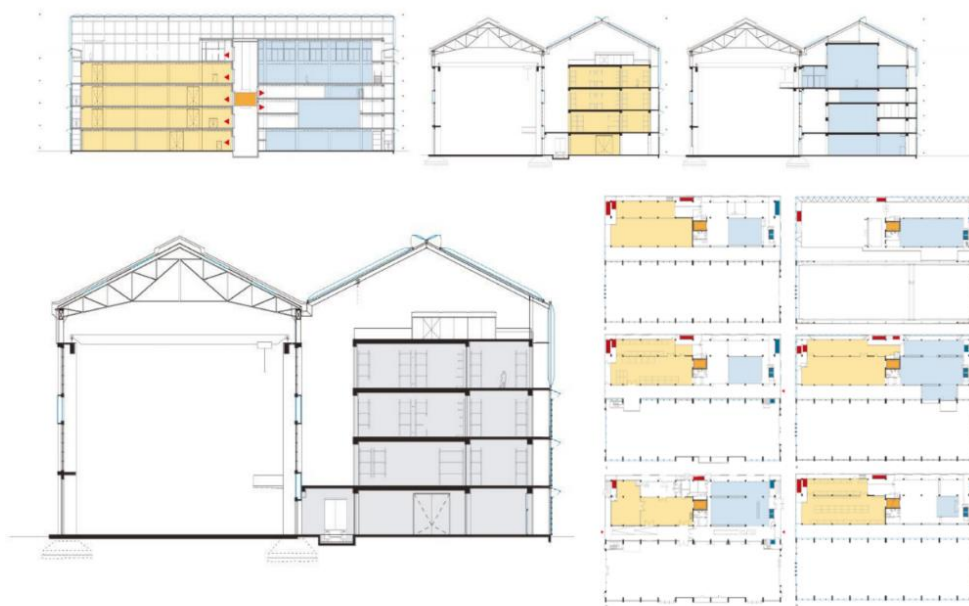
Plantas, cortes y secciones, FRAC Dunkerque. Fuente: Arquitectura Viva
